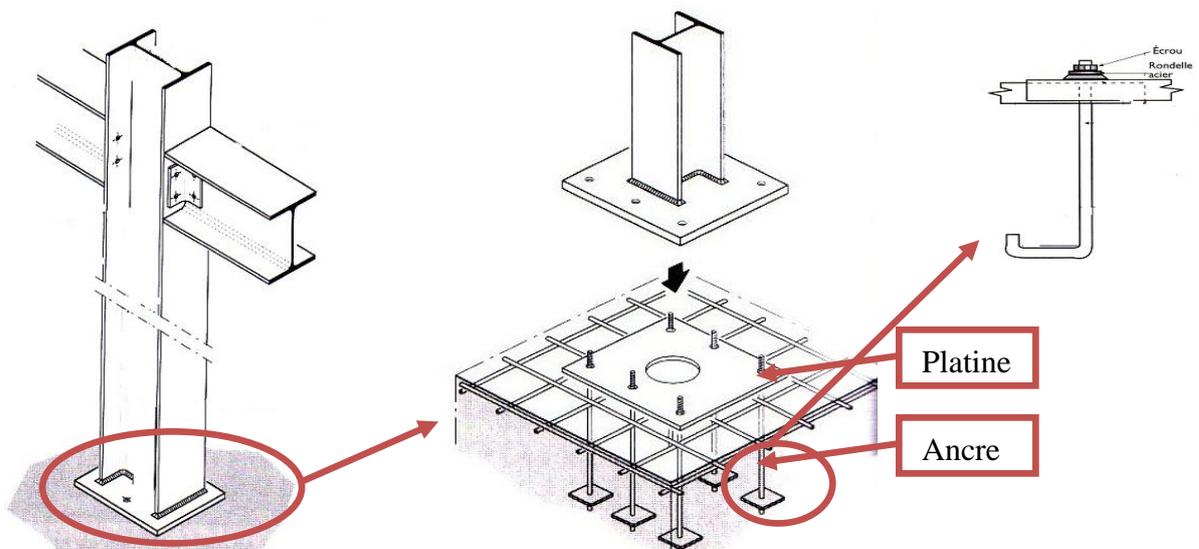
assemblage poteau-fondation. (Source : La conception de la charpente métallique)
